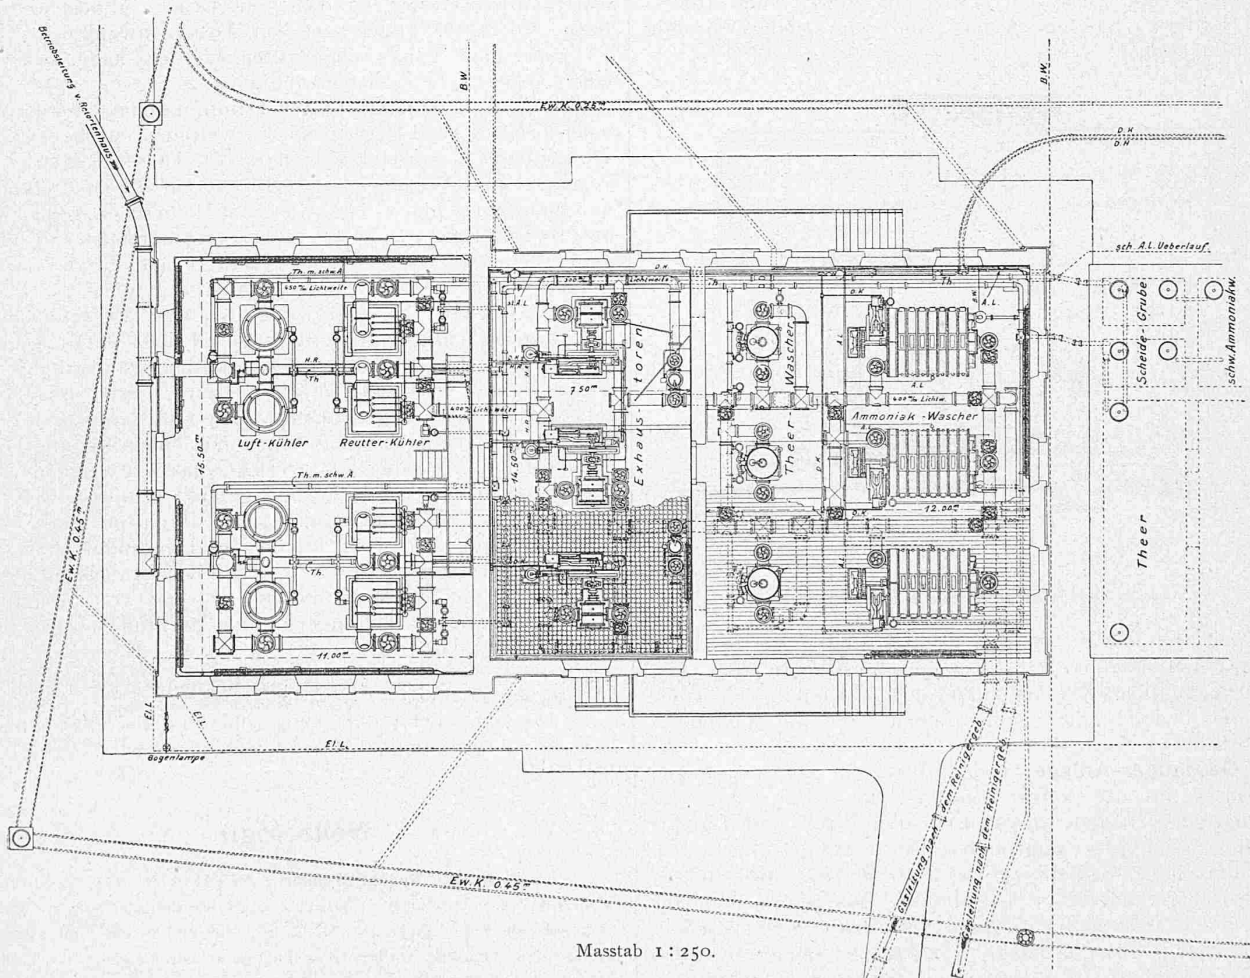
Grundriss des Apparatenhauses mit anschliessenden Theer- und Ammoniakwasser-Gruben.
